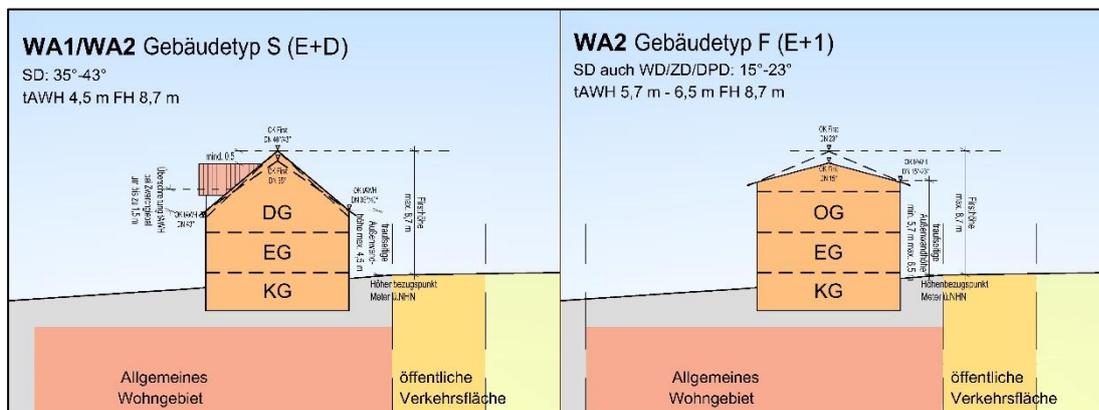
Systemschnitte Süd-Nord: vorgeschlagener Gebäudetyp S „E+D“ mit steilem Satteldach und zusätzlich beschlossener Gebäudetyp F „E+1“ hier mit flachgeneigtem Satteldach (Originalmaßstab 1/200)
